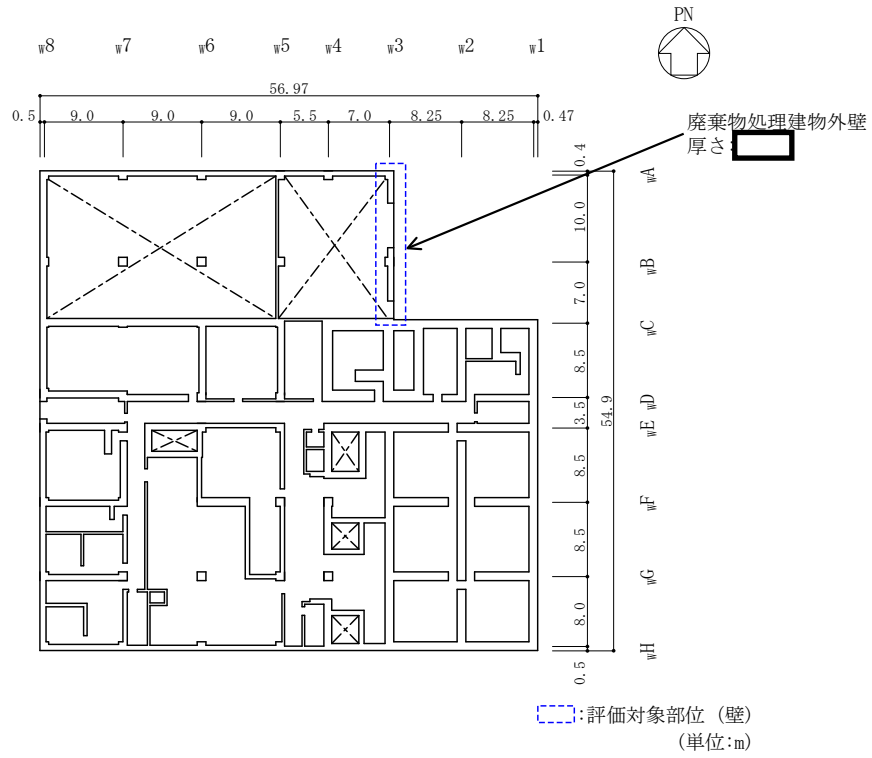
(1) 廃棄物処理建物の概略平面図 (EL 26.7m)
